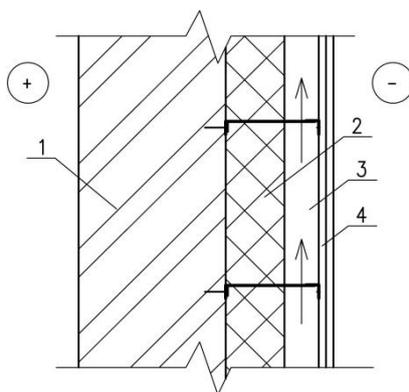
Пример двухслойной стеновой конструкции. (1) – кирпичная кладка; (2) – плиты минераловатные; (3) – вентилируемый зазор; (4) - наружный экран
